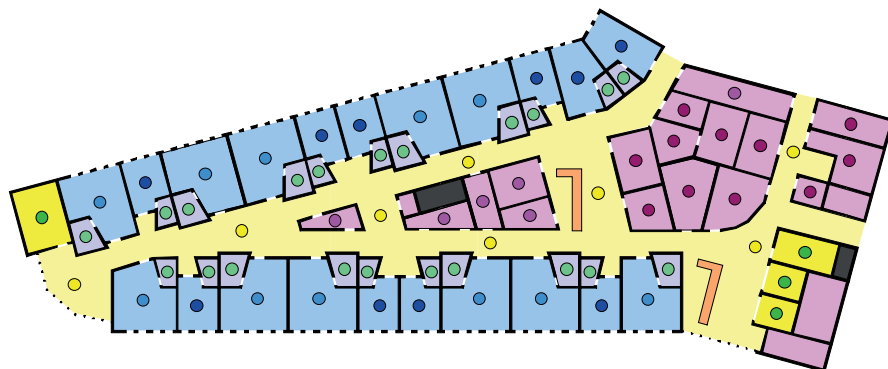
Funktionale Grundrissanalyse.
